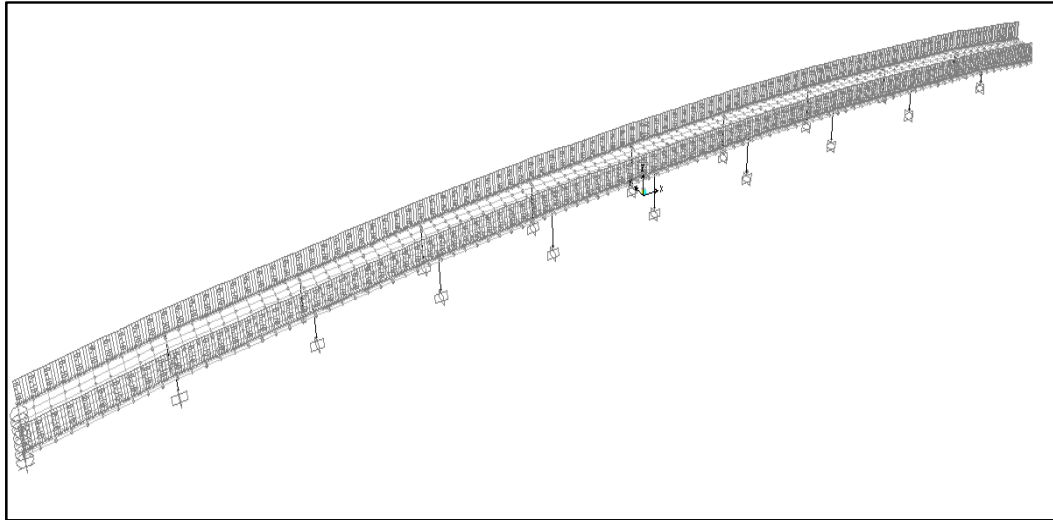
Carga de barandas uniformemente repartida en las vigas exteriores del puente.
